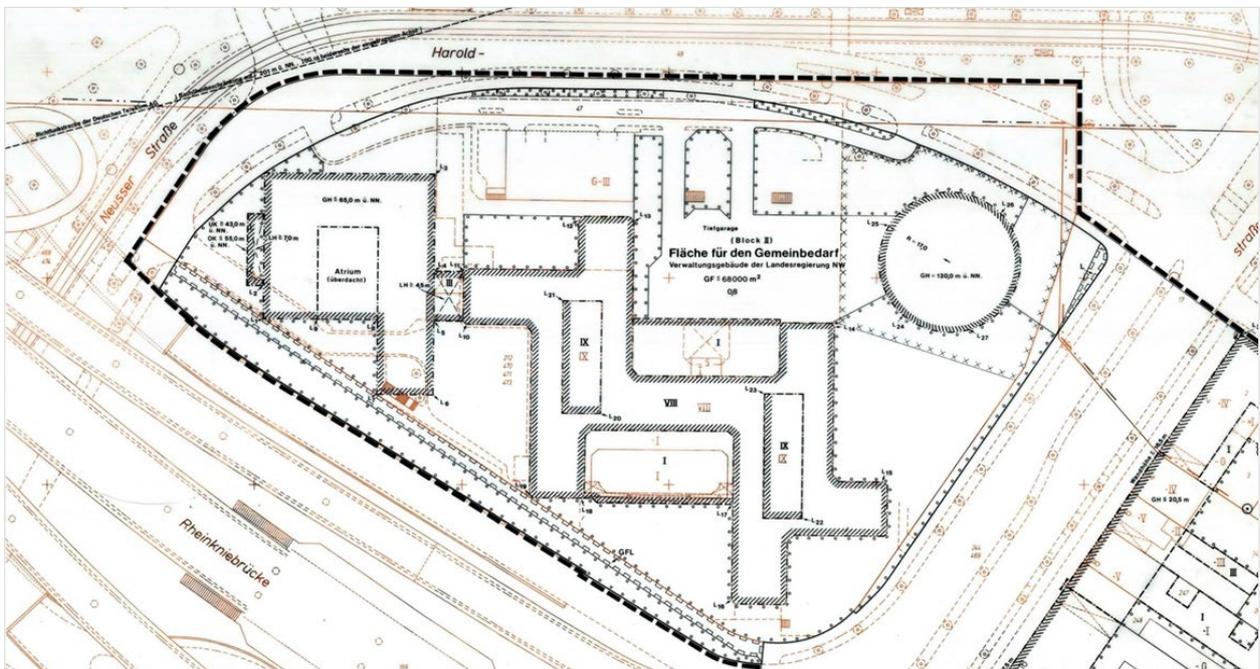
Rechtskräftiger Bebauungsplan von 1999
